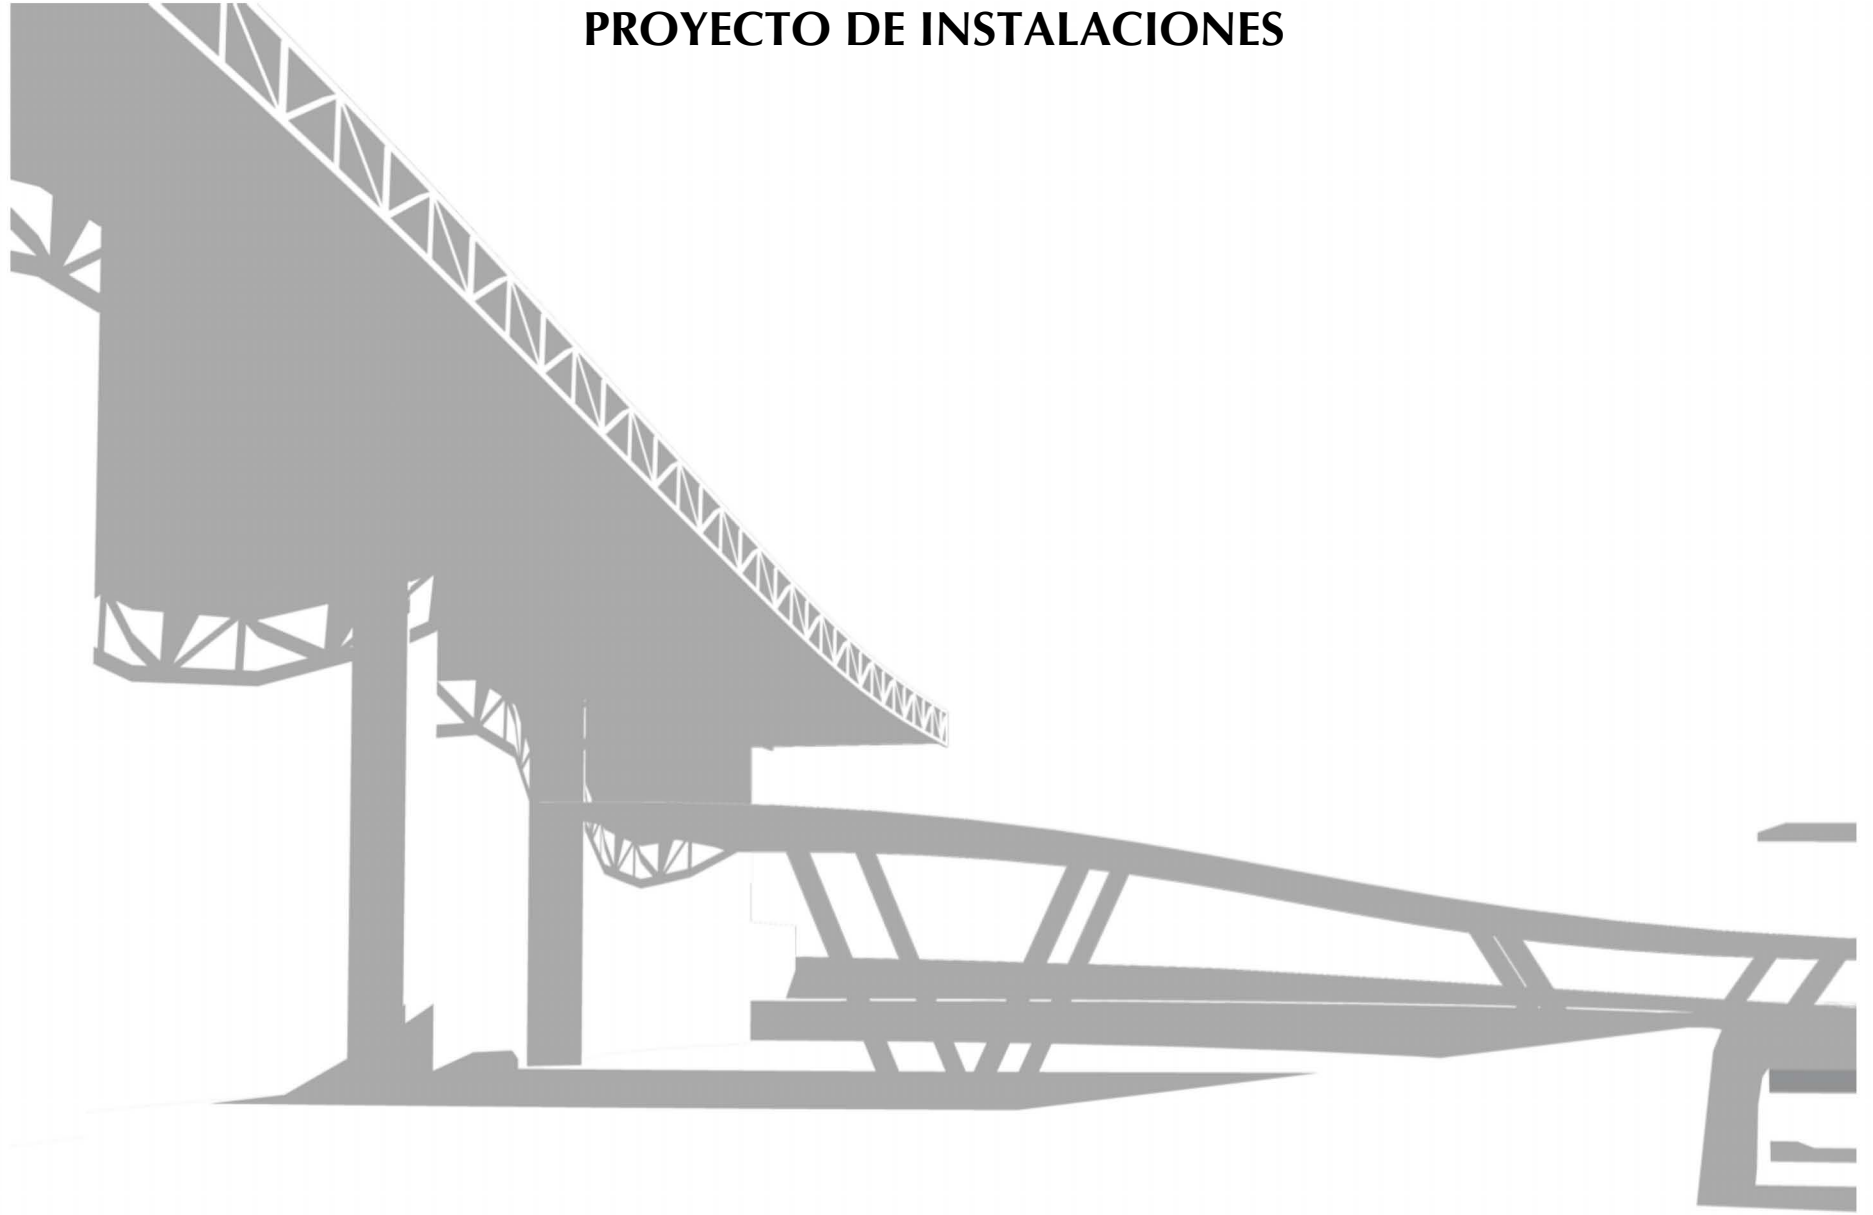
Siluetas Propuestas de Solución CCELA.* [48]
